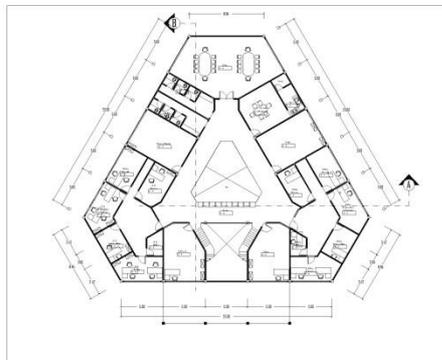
Denah Lantai 2 Ged. D (R. Pertemuan)
